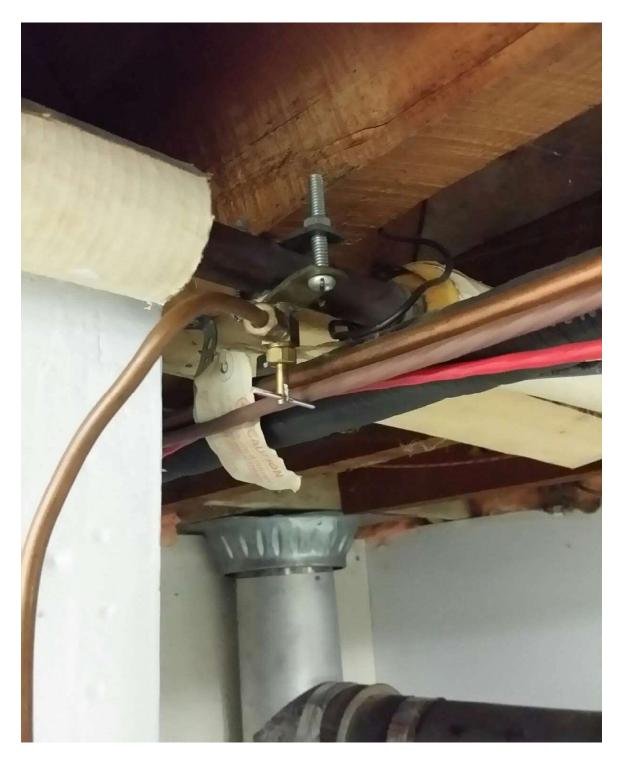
installations du poste frontalier de Glen Sutton Page 38 of - de 53
